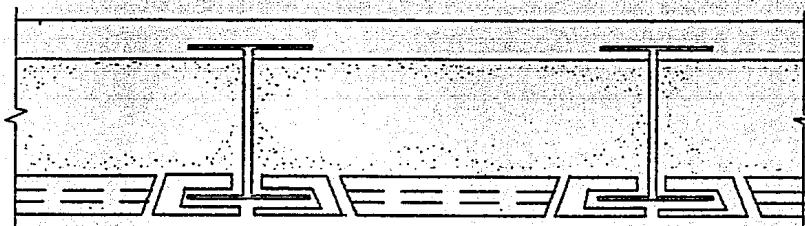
LOSA DE CONCRETO CON PLACAS DE CERAMICA SOPORTADAS POR VIGAS DE ACERO
